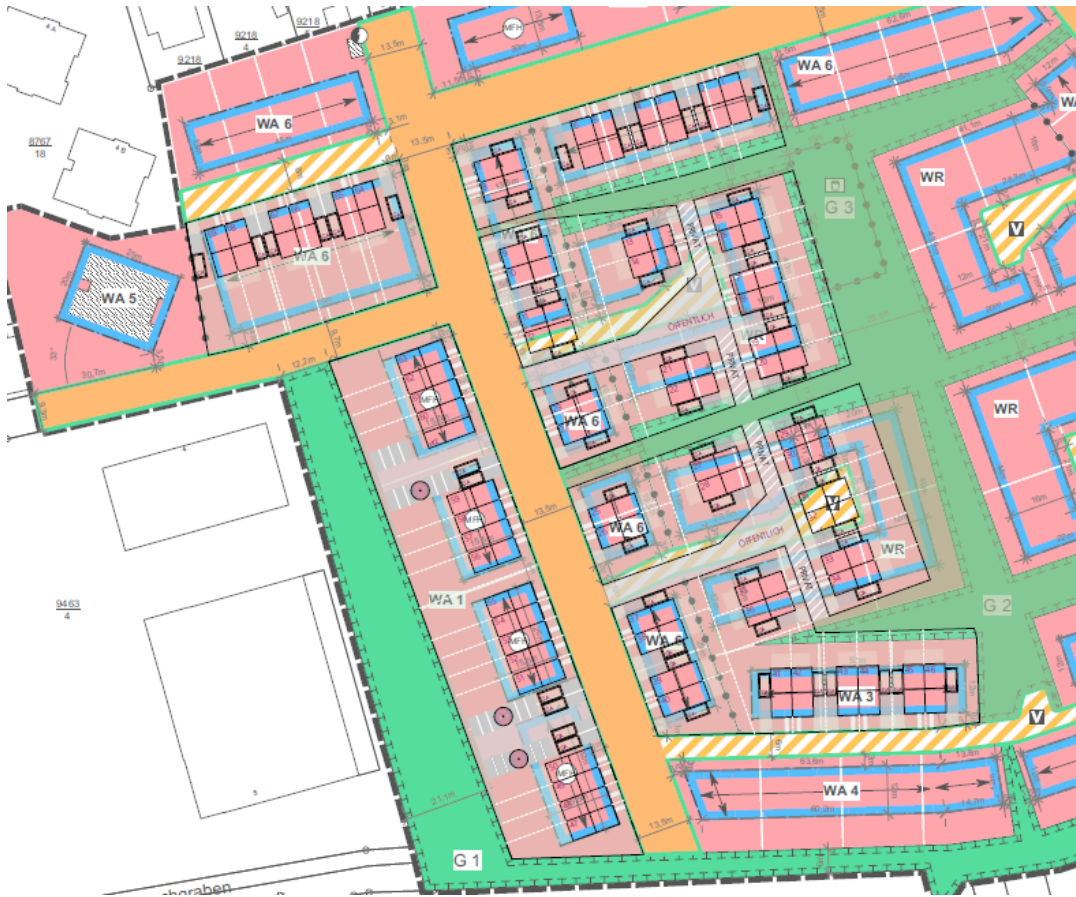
Darstellung Bebauungsplanentwurf und Bebauungskonzept Traumhaus AG überlagert
